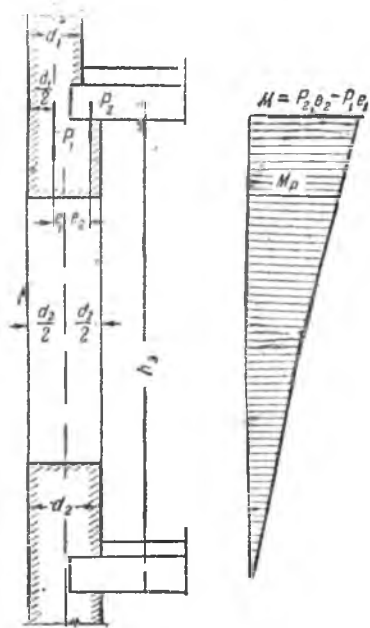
Эпюра моментов от перекрытия и кладки вышележащего этажа в стене с обрезом
